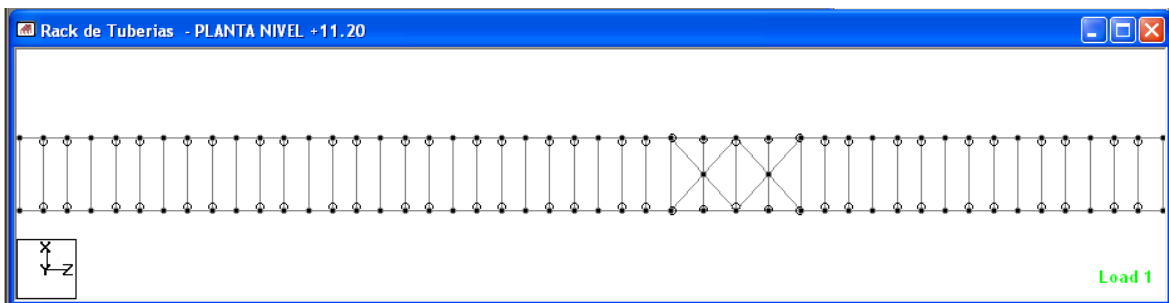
Modelo analítico planta estructural nivel 11.20
